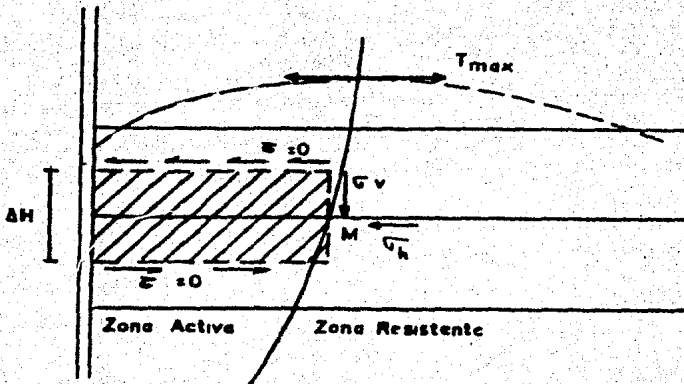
Equilibrio de un prisma elemental y cálculo de la Tensión Máxima.
